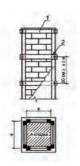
Схема усиления каменных колонн и простенков. 1 – планка сечением 35х5 – 60х12 мм; 2 – сварочный шов.
